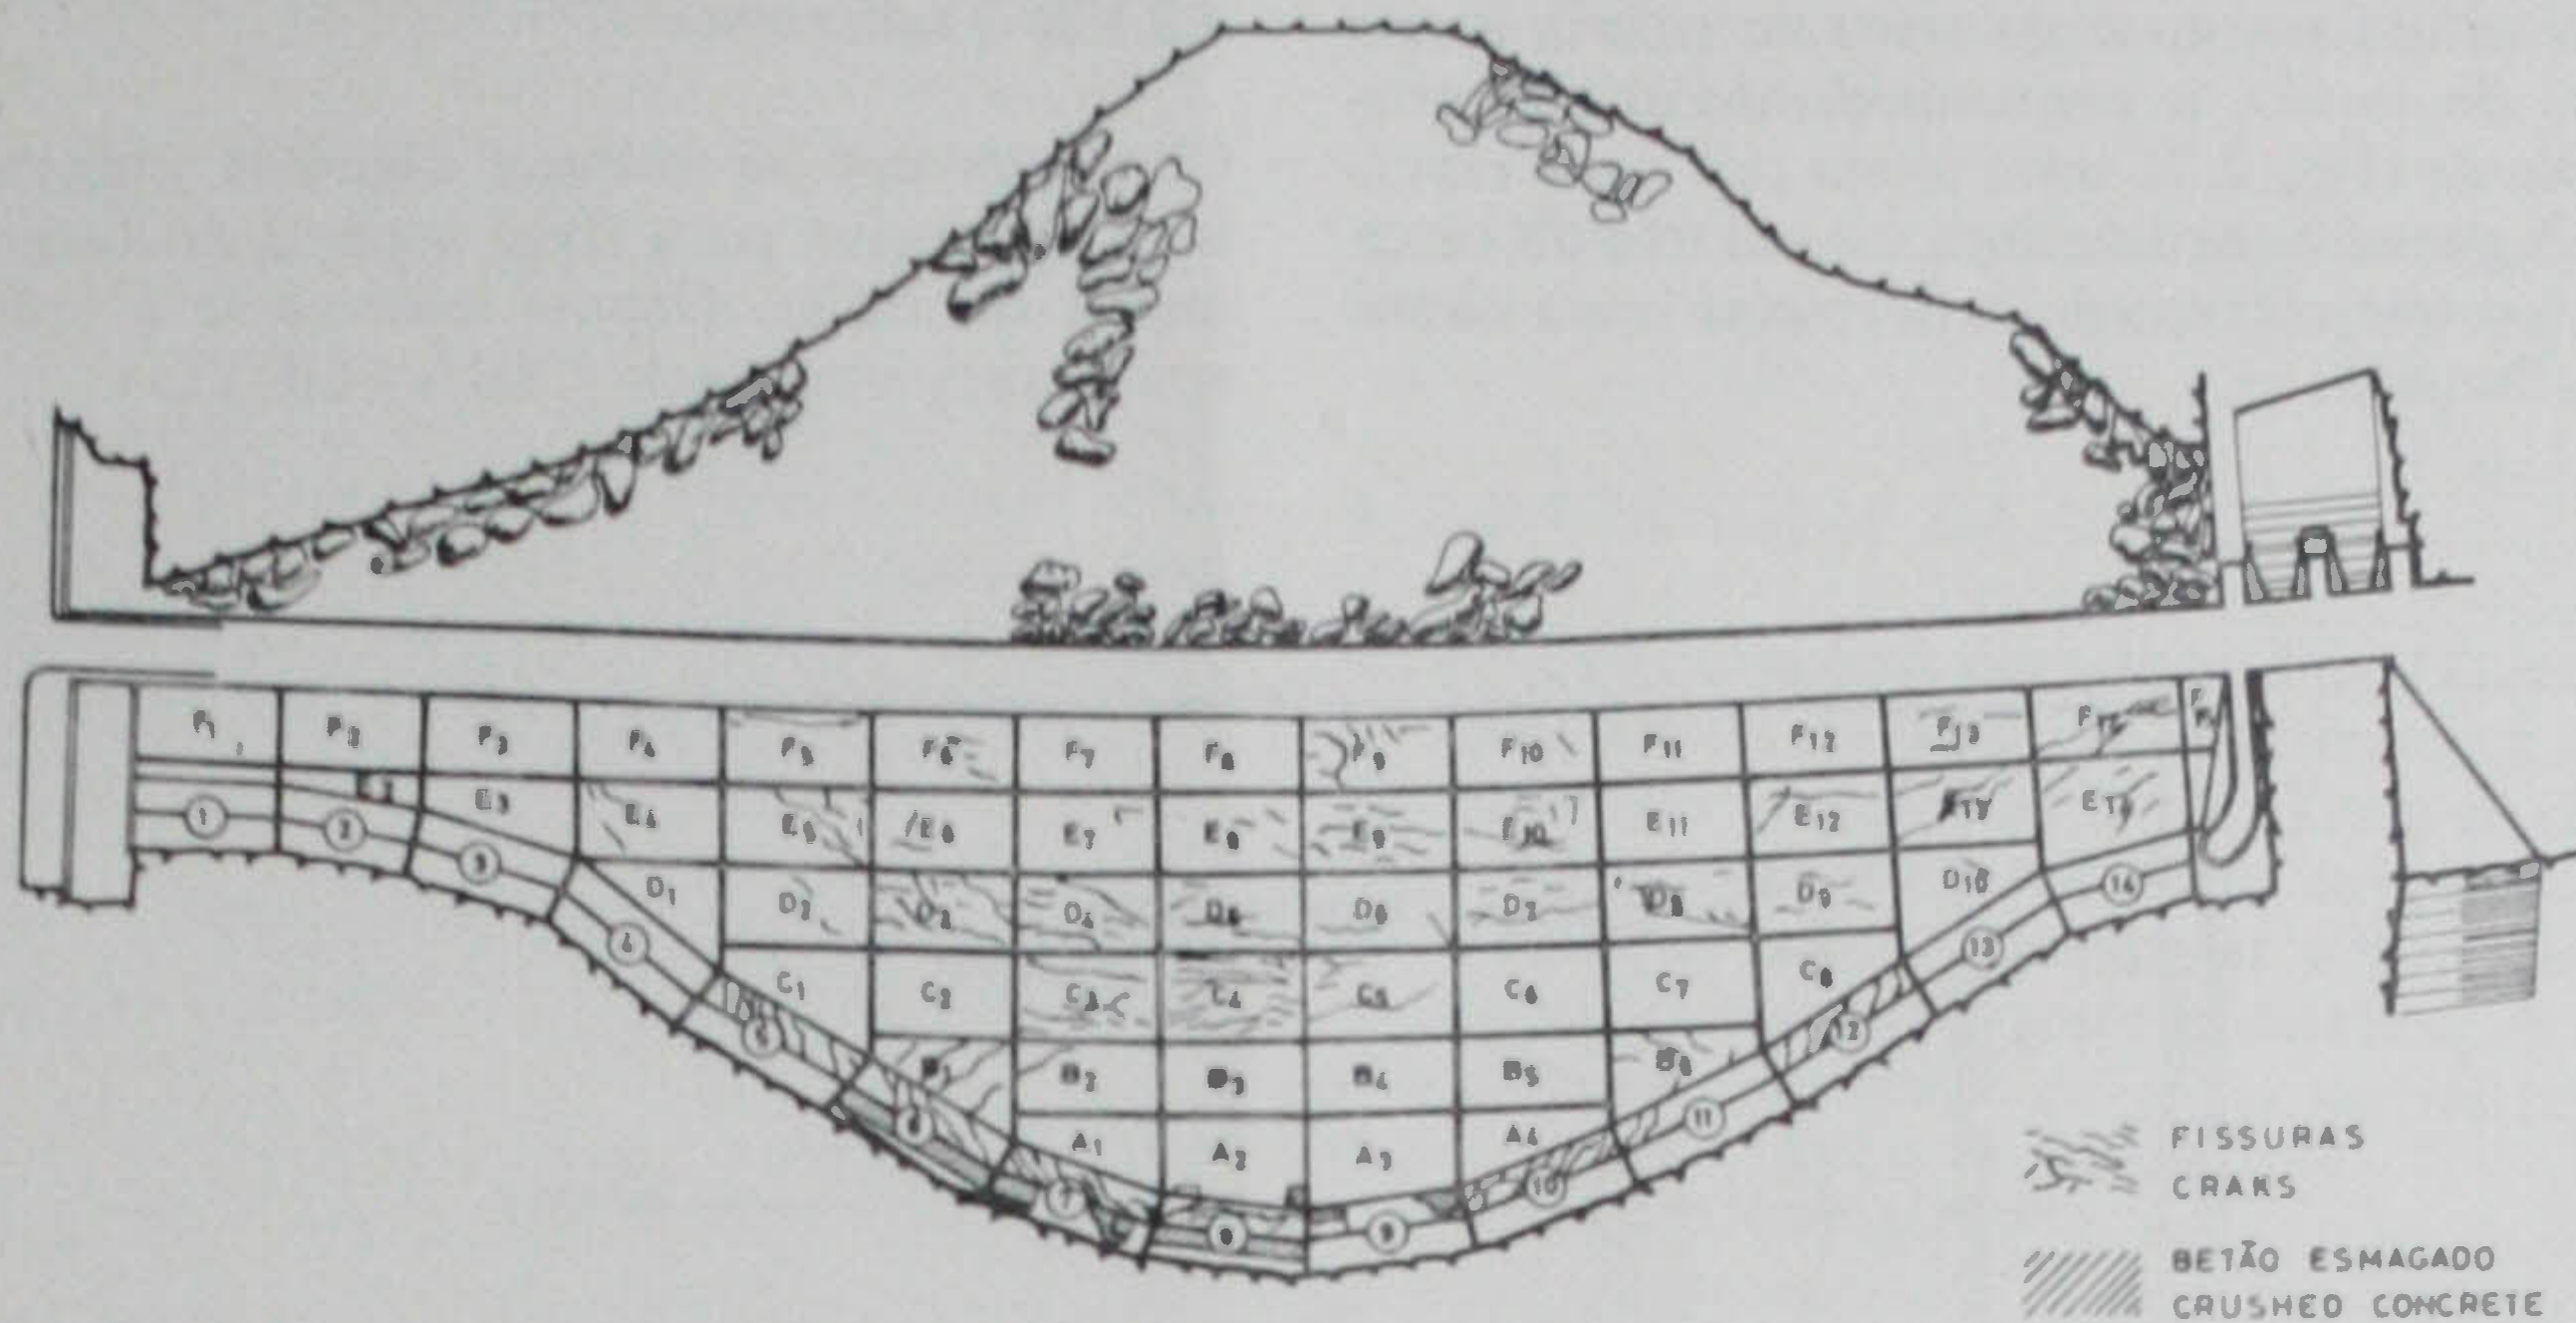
Planta da Barragem de Vilar — Rio Távora (Douro)
